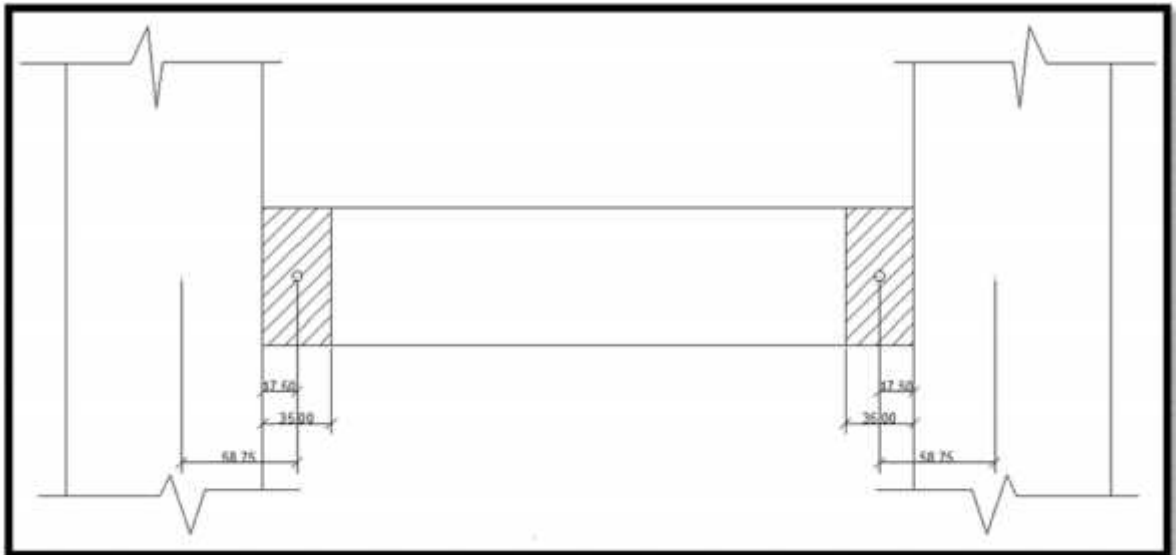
Rotulas plásticas en viga del tramo 1 del pórtico B-B
